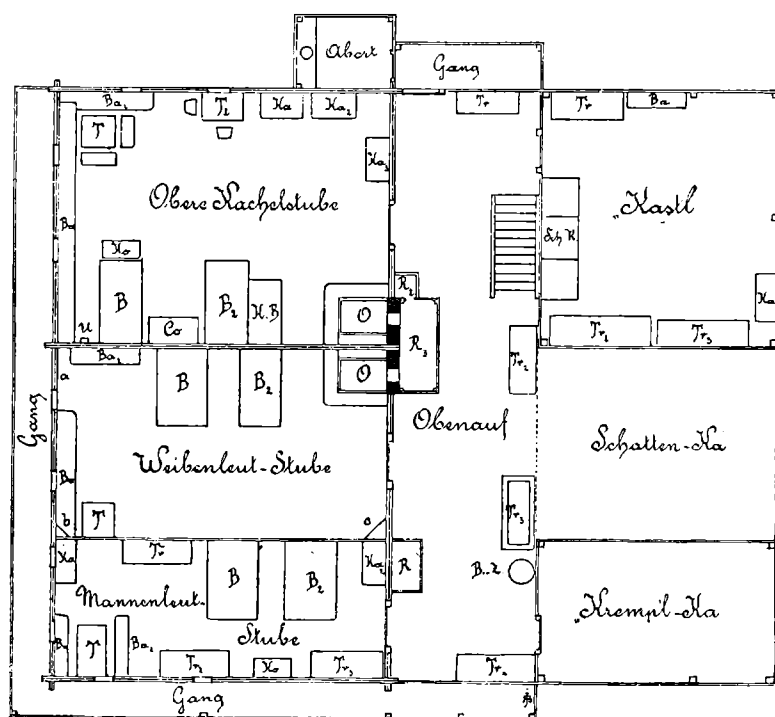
Grundriss des Obergeschosses des Hofer-Hauses.
